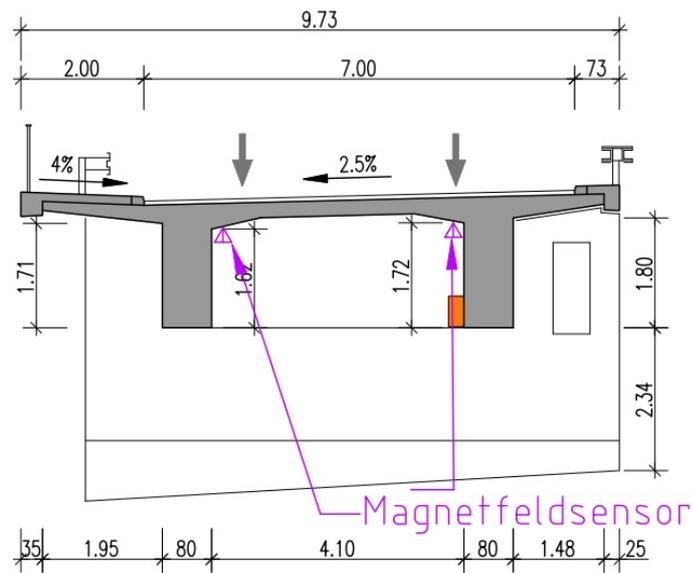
Lage der Magnetfeldsensoren im Querschnitt; Quelle: Büro für Strukturmechanik GmbH
